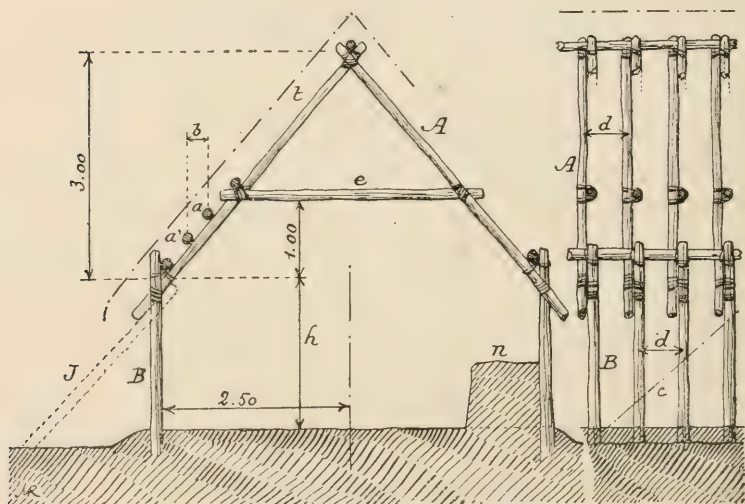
Construction en bois (coupe transversale et vue en long).
